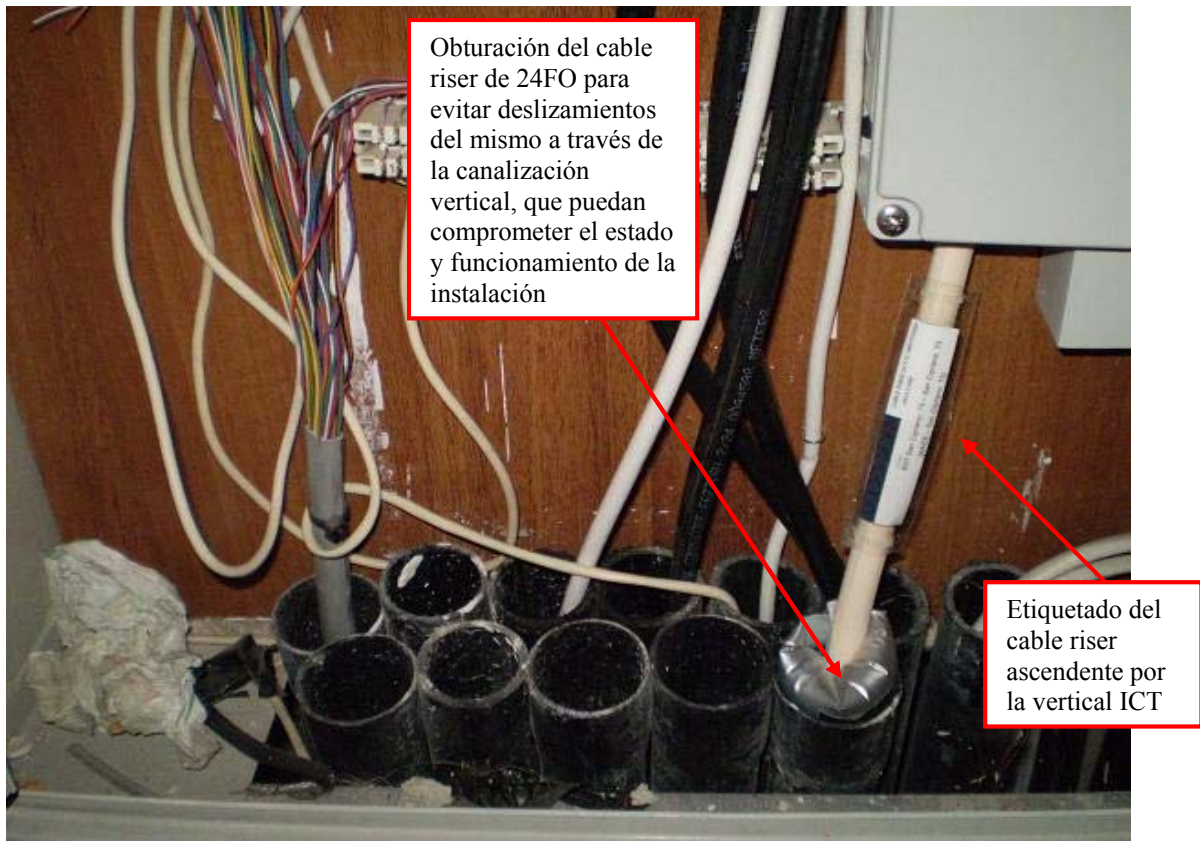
Vista tubos PVC de la canalización ICT del edificio para paso de cables en planta 5ª
